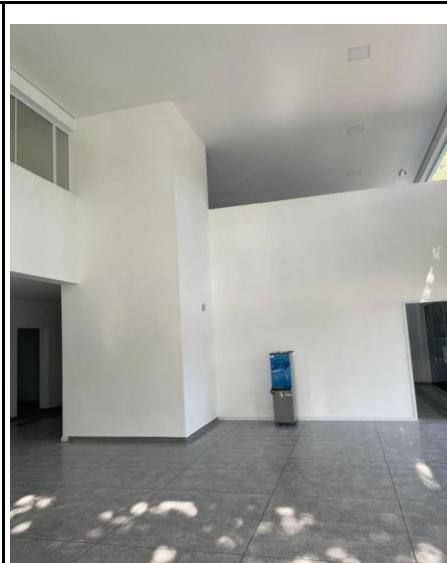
VISTA INTERNA EDIFICAÇÃO
